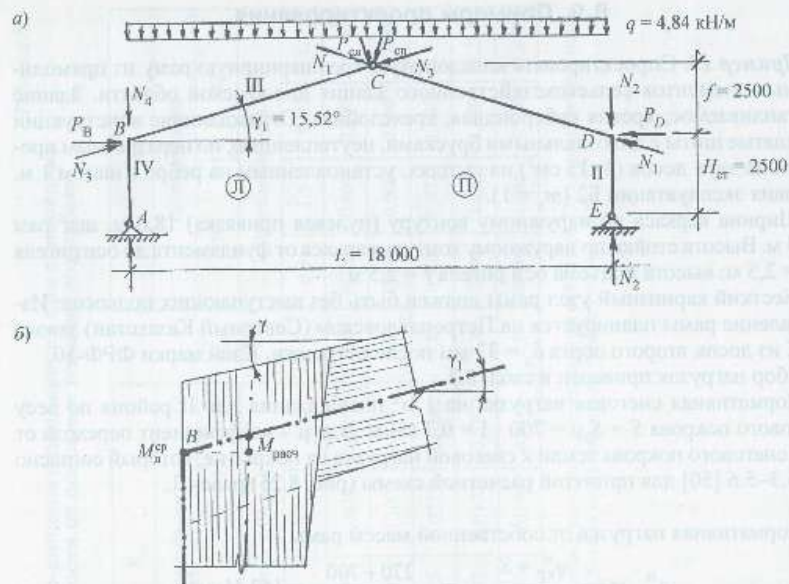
Расчетные схемы: а – рама по наружному контуру стойки и оси ригеля для расчета на ЭВМ; б – карнизного узла для переноса усилий на ось рамы
